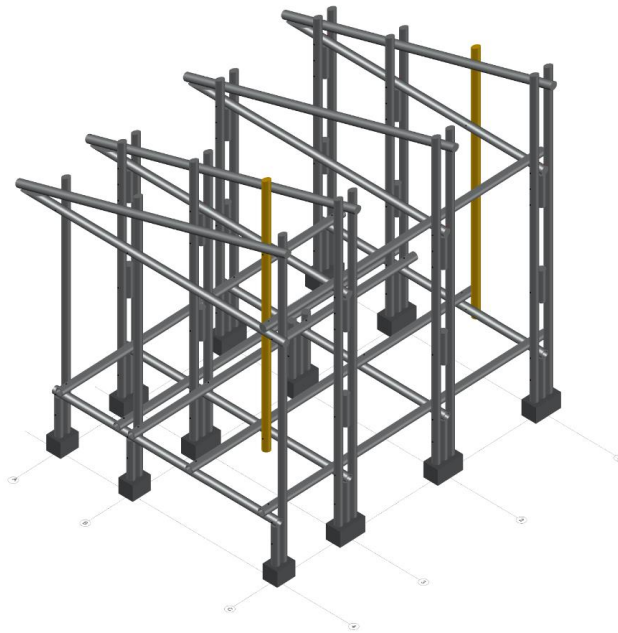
Columnas auxiliares. Fuente: Elaboración Propia
